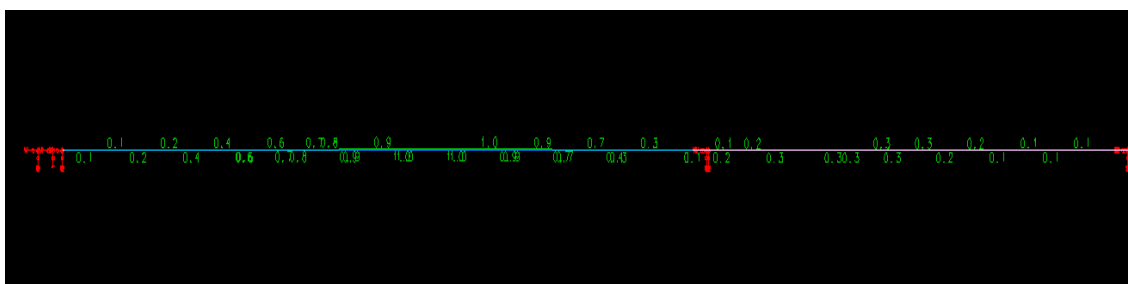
Deslocamentos verticais viga V11 do 1º pavimento, concreto protendido (CAD/TQS).
